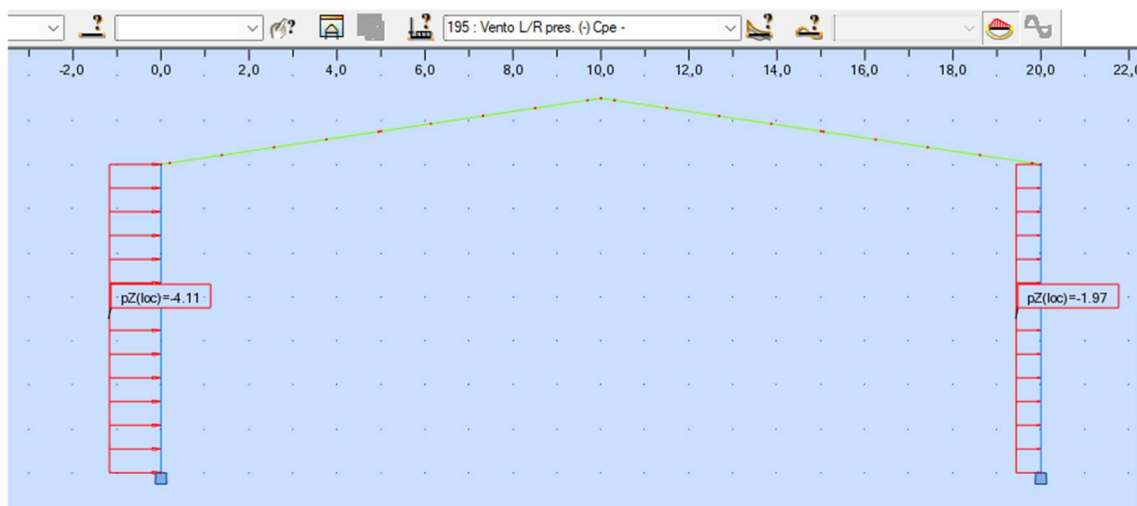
Carga característica “Vento L/R pres. (-) Cpe –“ aplicada no pórtico 1
